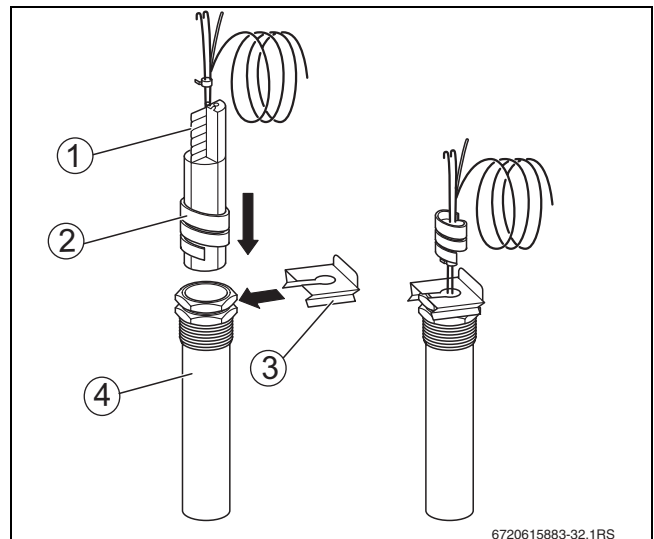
Inserire la spirale di plastica nel pozzetto ad immersione
